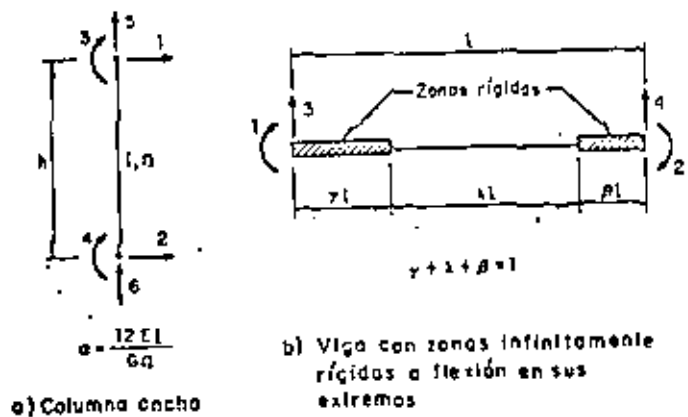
Notación y grados de libertad para columnas y vigas en el método de la columna ancha
